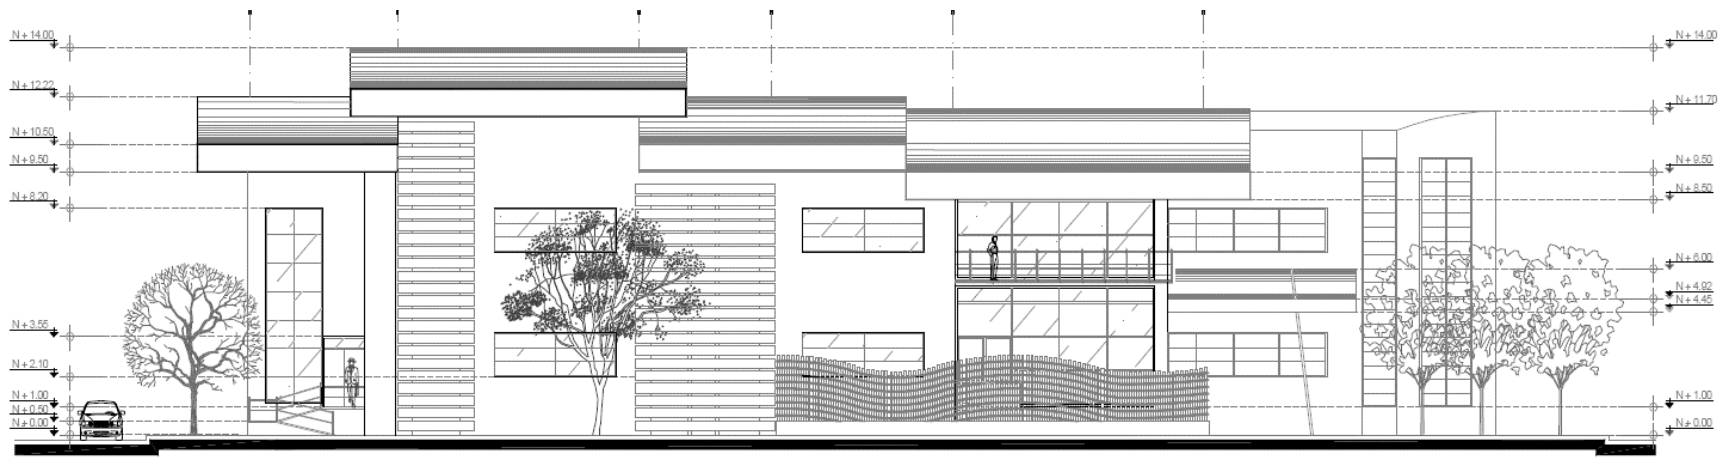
Fachada Sur (Tomada de TESIS-UNAM)
